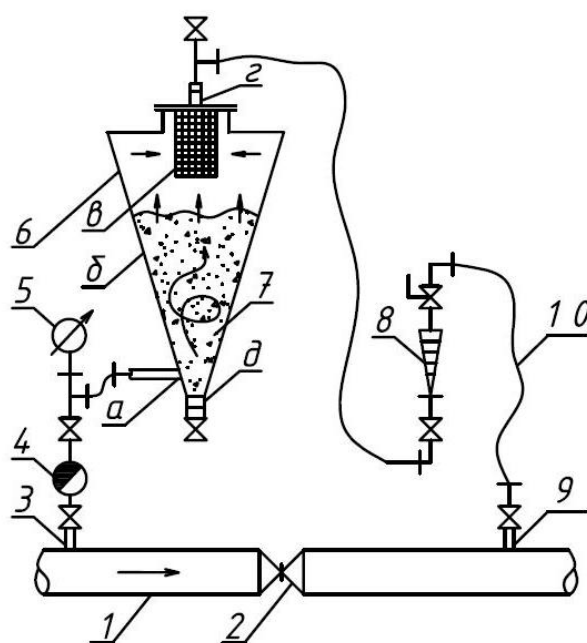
Мобильное реагентного устройство: а – входной патрубок; б – корпус; в – дренаж из пористого полиэтилена; г – выходной патрубок; д – патрубок опорожнения; 1 – напорная водопроводная линия; 2 – задвижка; 3 – патрубок; 4 – расходомер; 5 – манометр; 6 – реагентный аппарат; 7 – твердый реагент; 8 – ротаметр; 9 – патрубок ввода реагента; 10 – шланг
